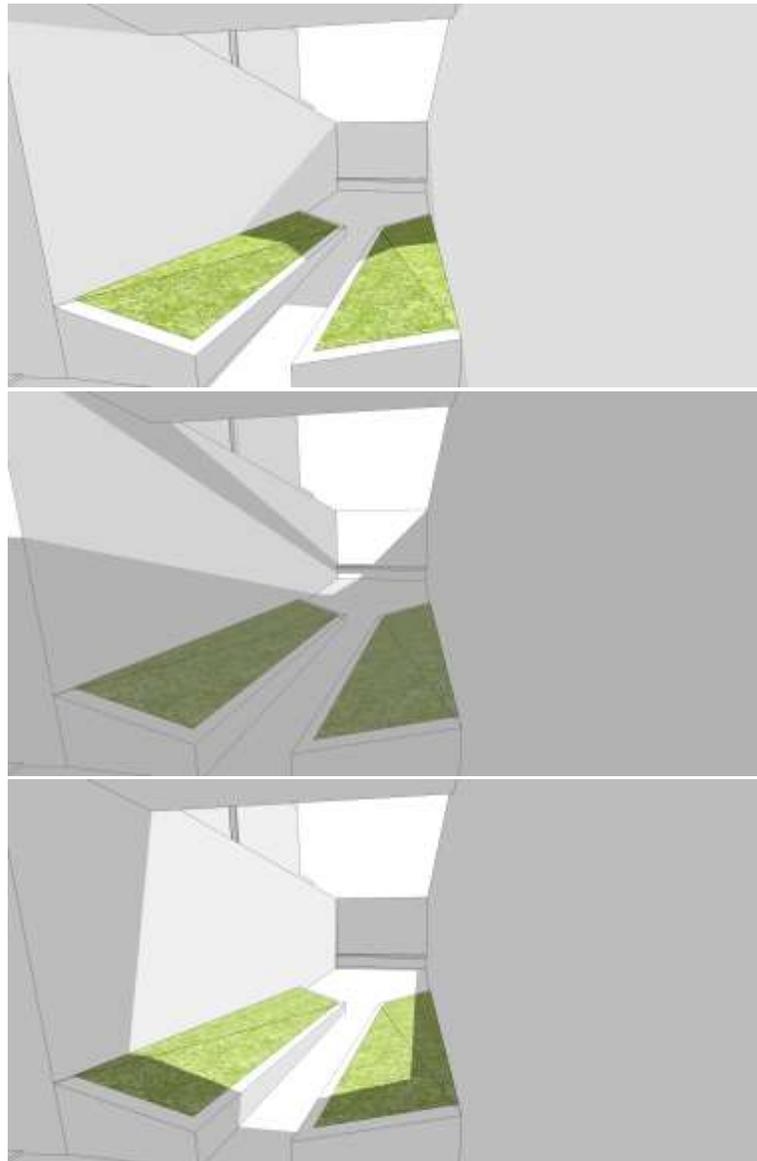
, FIGURA 142 Y FIGURA 143. Volumetría con soleamiento en terraza, planta primer nivel.
